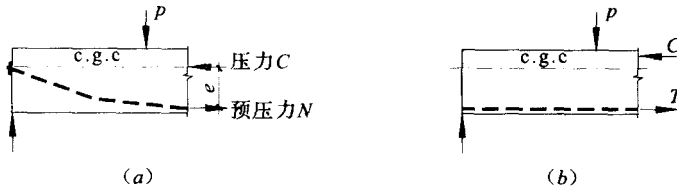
预应力混凝土与钢筋混凝土梁内的内部抵抗力矩
